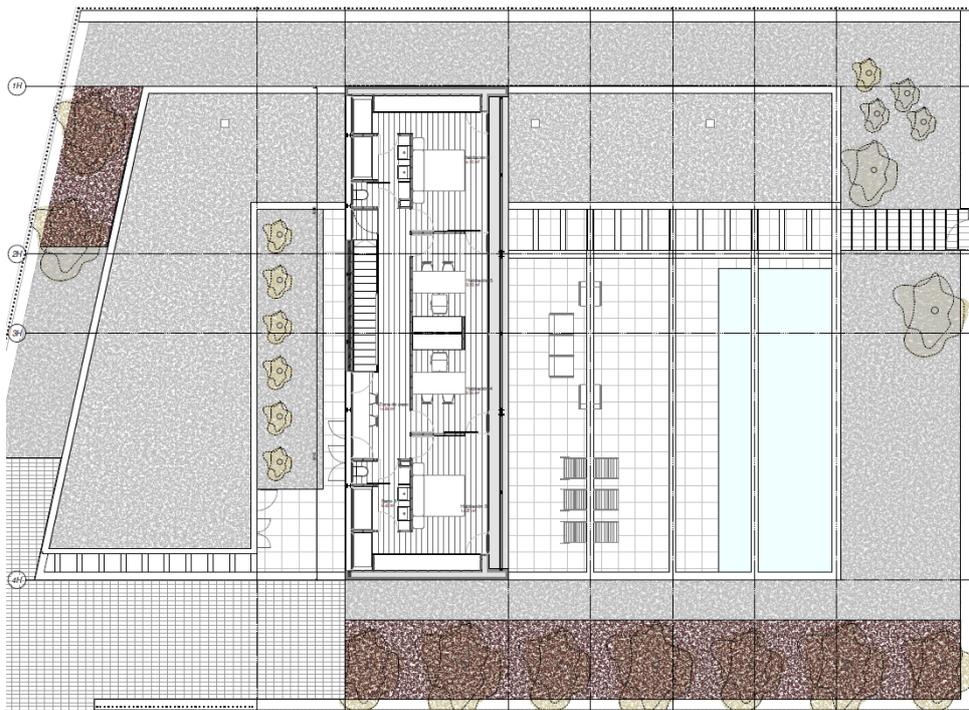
Plano de planta primera. 2019. Planos del Proyecto
